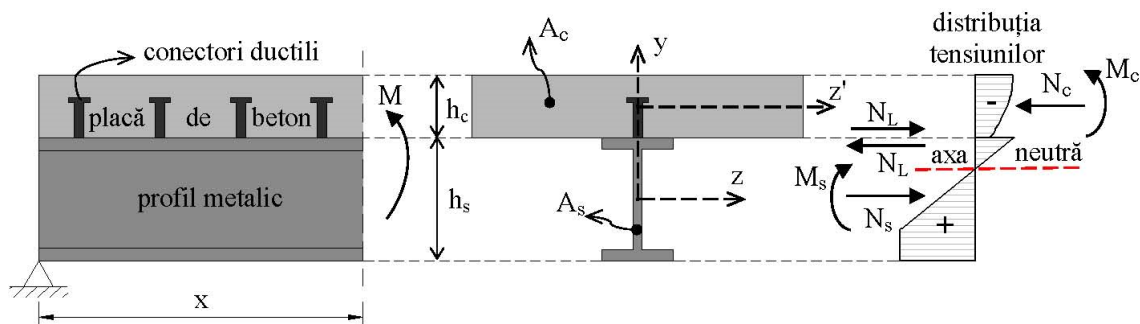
Grindă mixtă oțel-beton. Distribuția tensiunilor normale pe secțiune.
